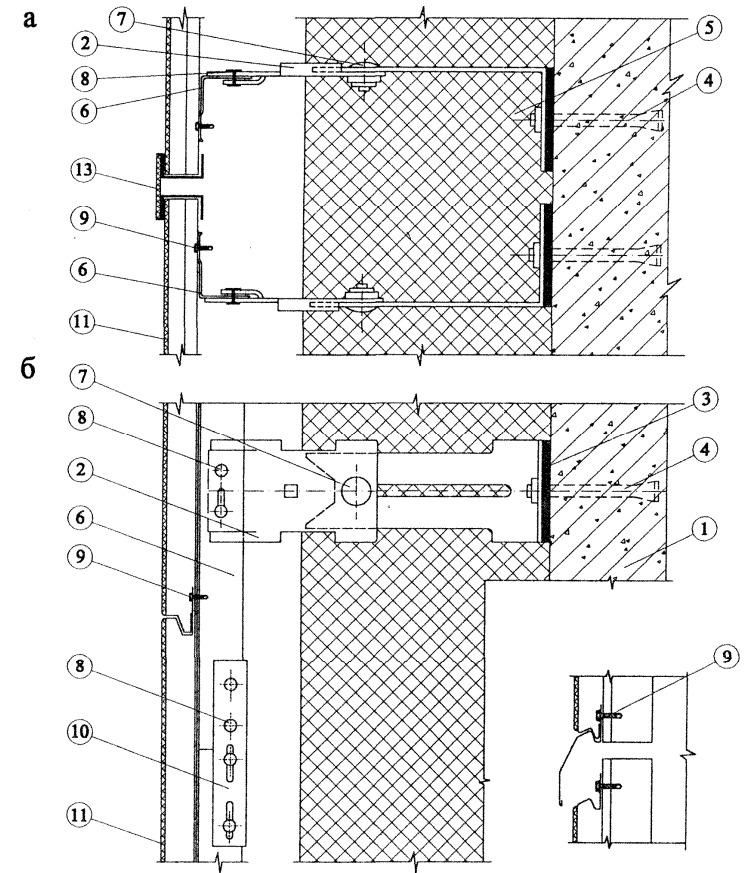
Разрез фасадной системы с облицовкой панелями «КраспанМеталлСтоун»
